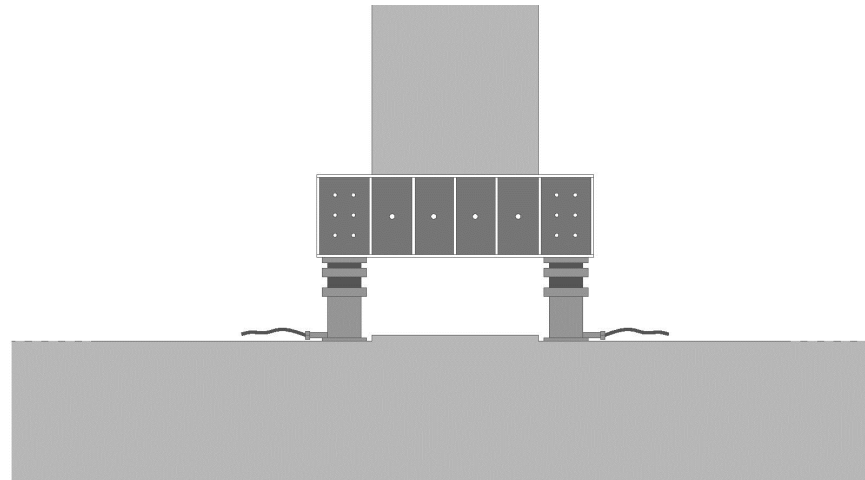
18 – Taglio del pilastro in calcestruzzo armato con sega a filo diamantato ed estrazione della porzione in eccesso
